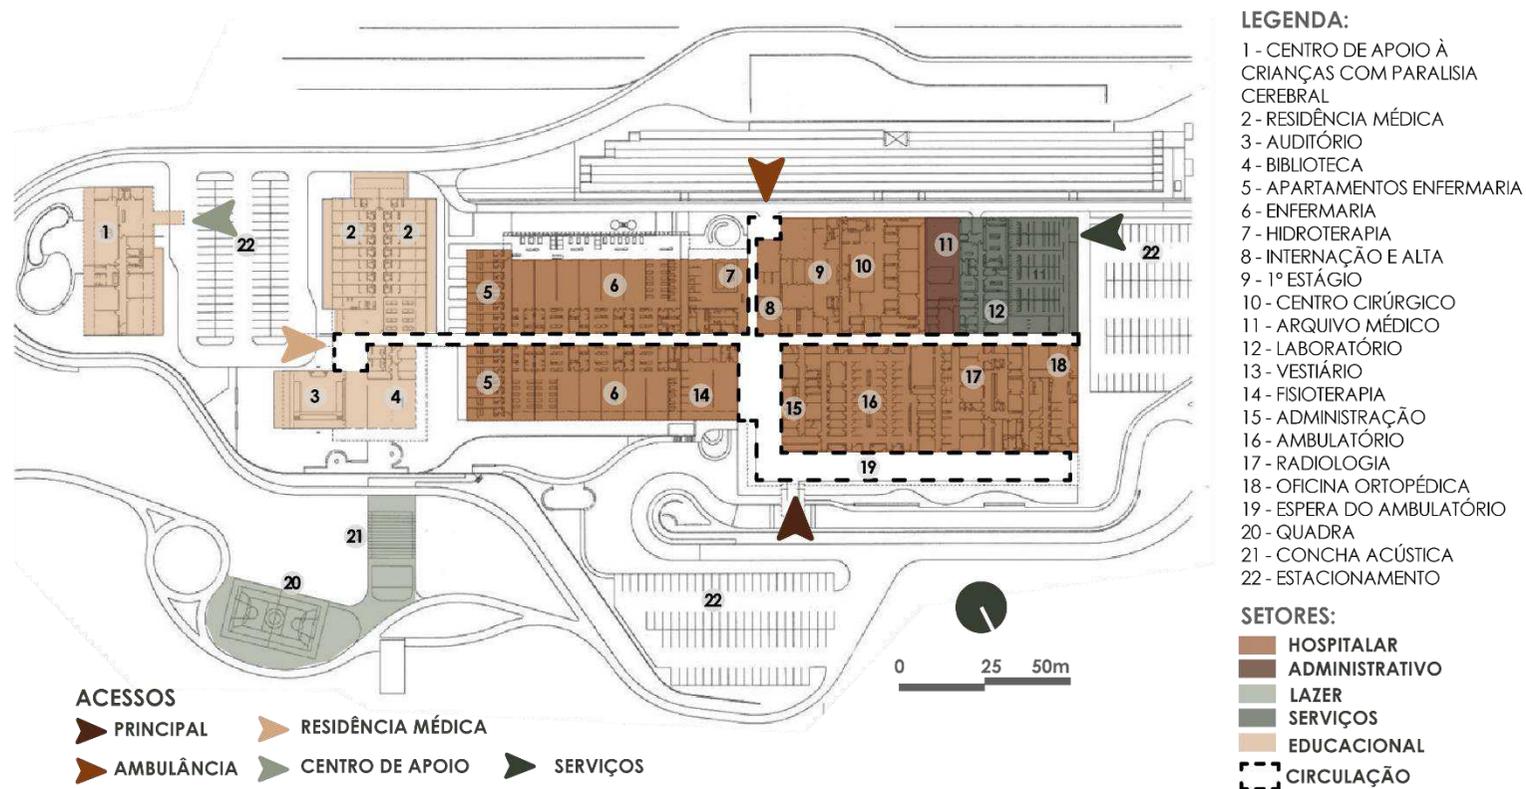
Planta baixa zoneada - Pavimento térreo
